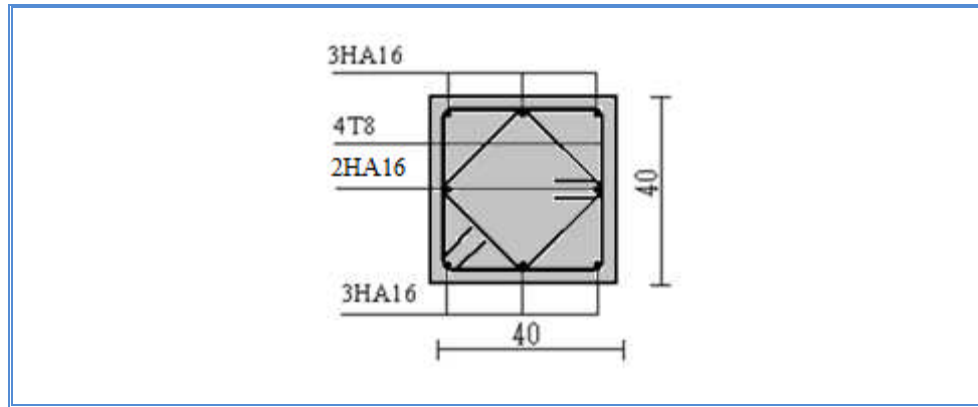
Ferrailage des poteaux du RDC, 1^{ère}, et 2^{ème} étage.
